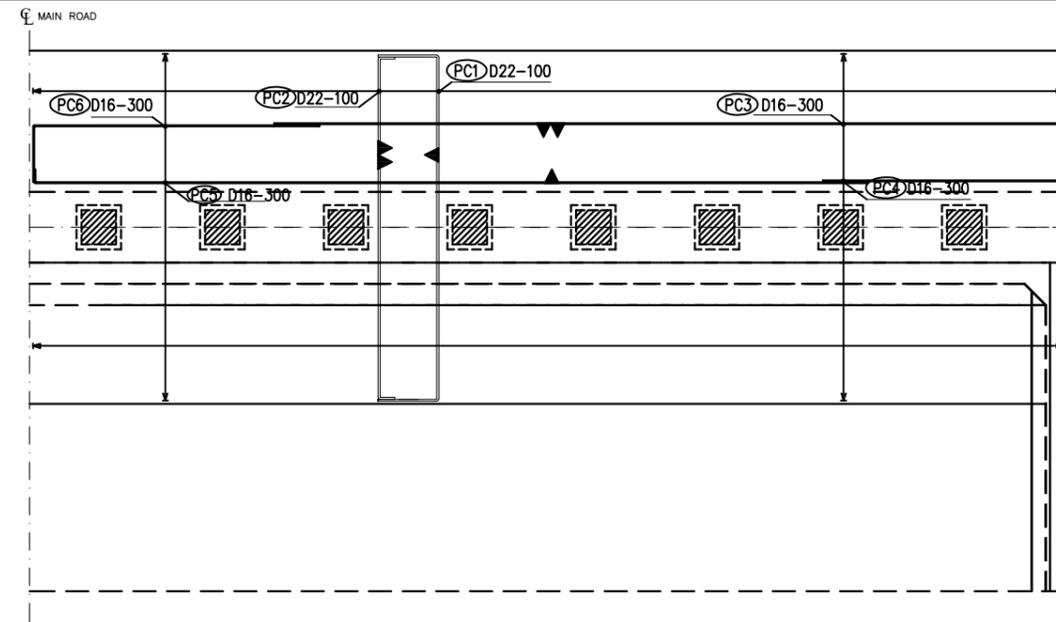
DETAIL PENULANGAN PLAT LANTAI KANTILEVER
